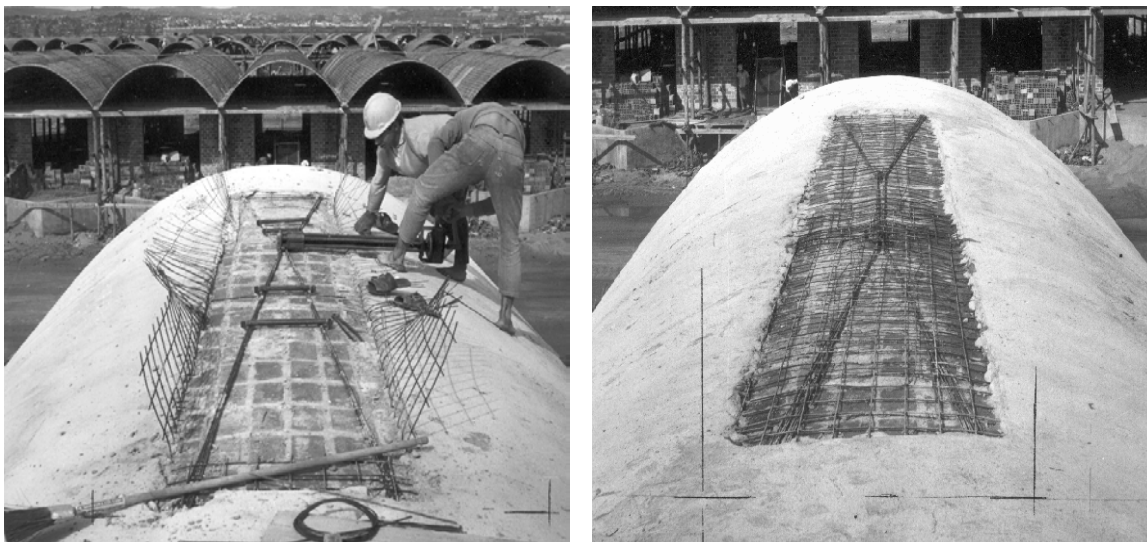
Abóbadas autoportantes: protensão dos cabos na parte superior e colocação de malha eletro-soldada.
